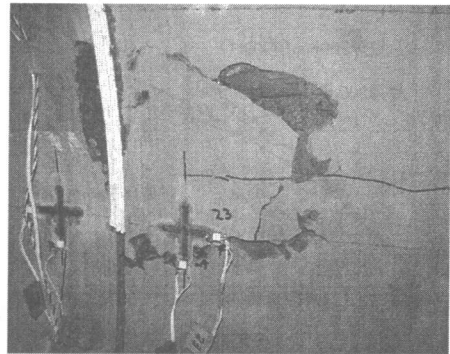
短管のひび割れ状況 (5.87MN時)
